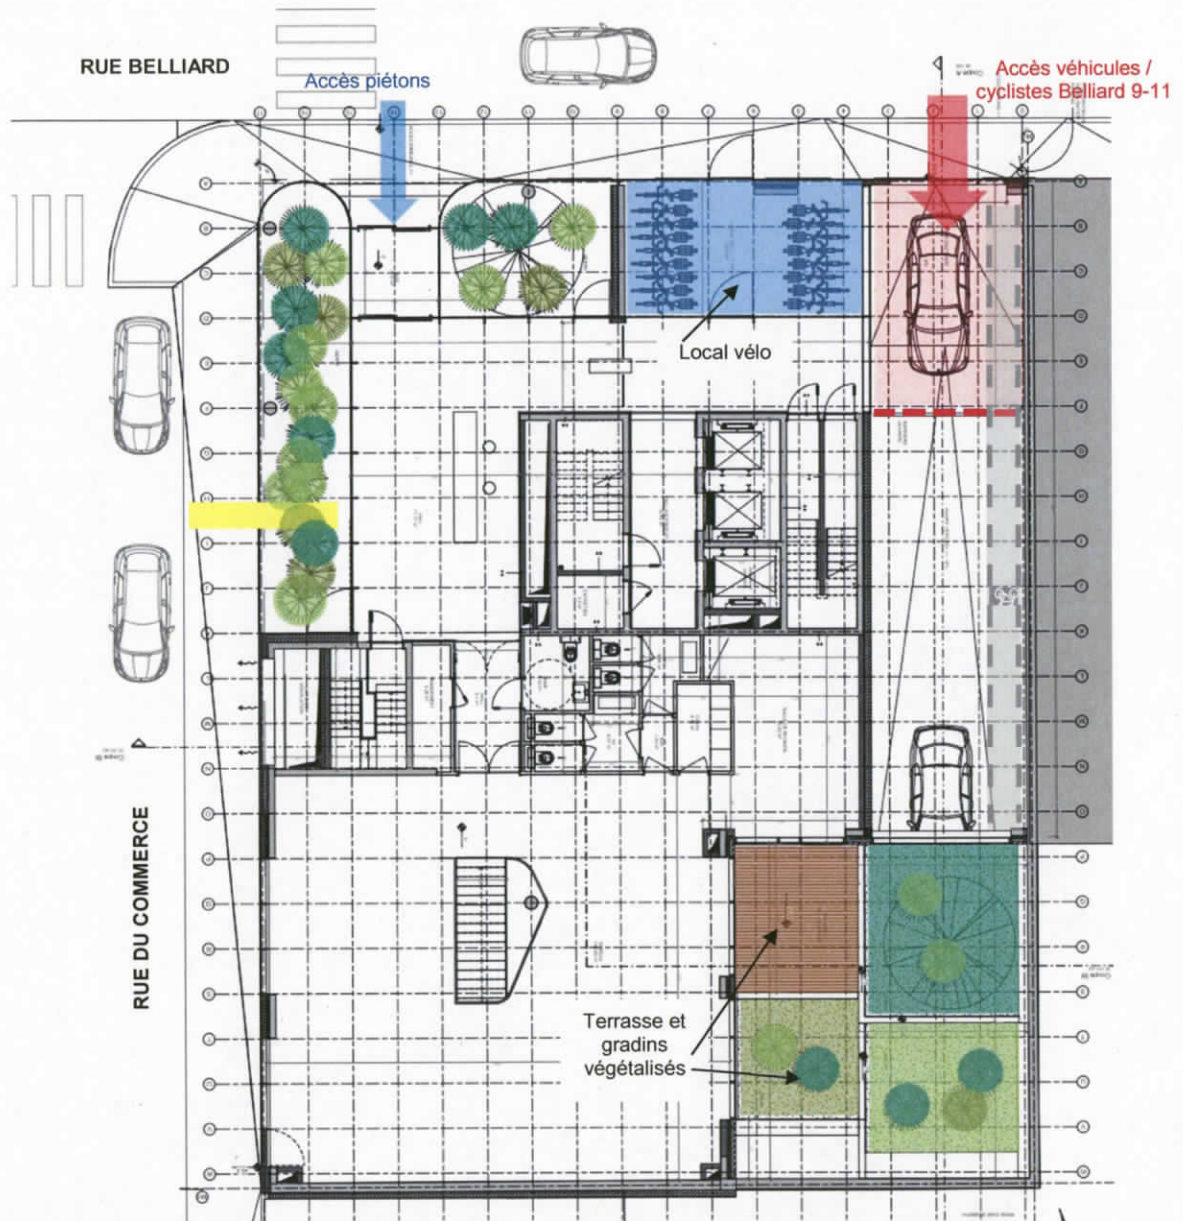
Organisation spatiale du rez-de-chaussée (Source : A&B 2018)
